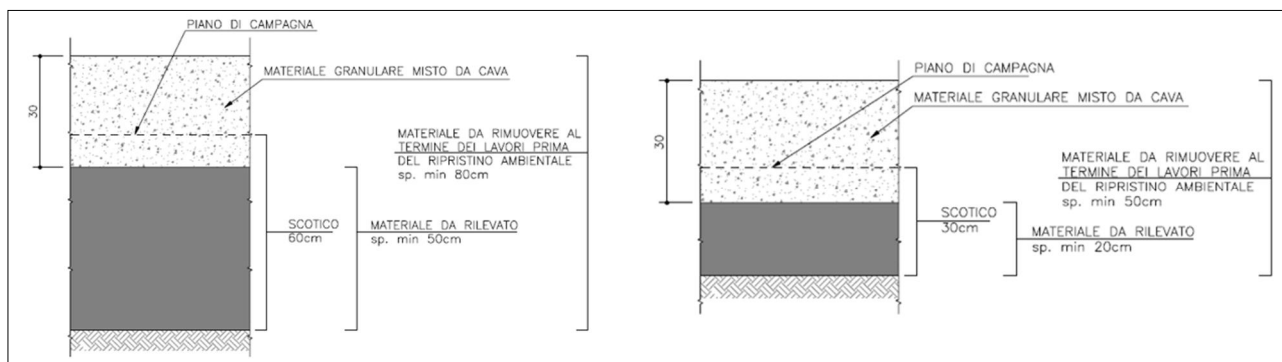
Pacchetti di pavimentazioni previsti nei campi travi
